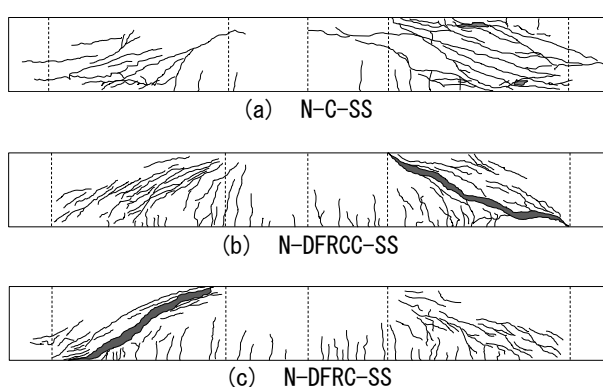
RC梁載荷試験により得られたひび割れ発生状況
